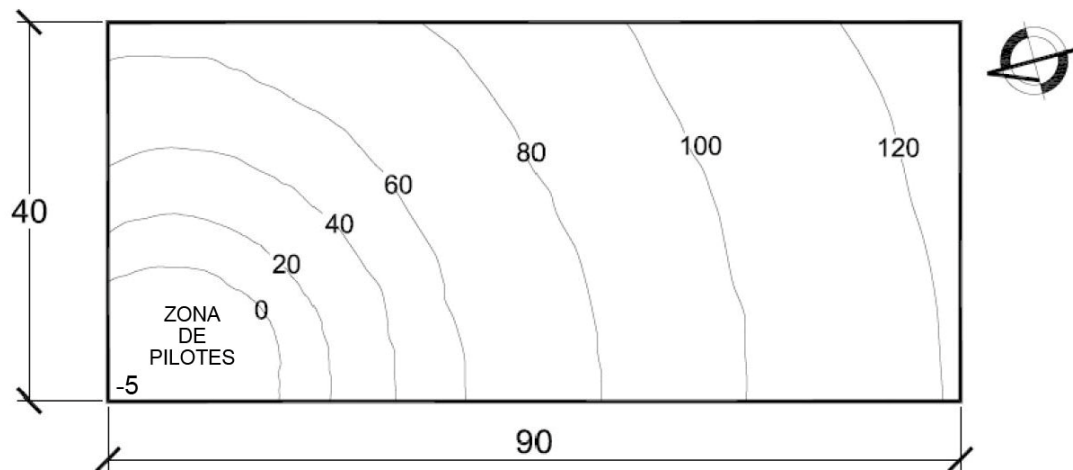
Curvas de nivel medidas en la planta del edificio.
